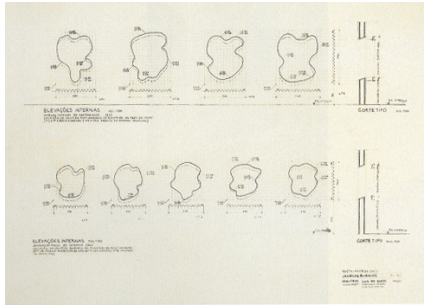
Detalhe de execução das janelas do Restaurante do Coati.
